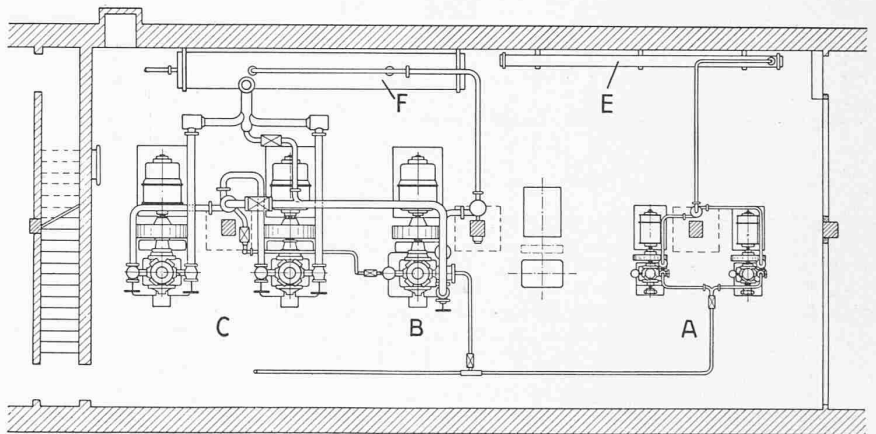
Grundriss des Maschinenraums. A Kompressoren für das Gefrierkonserven-Lager, B Verbundkompressor, C dritte Verdichterstufe (Booster), E Kondenser für die Lagerkühlung, F Kondenser für die Tiefkühl-Tunnelanlage
